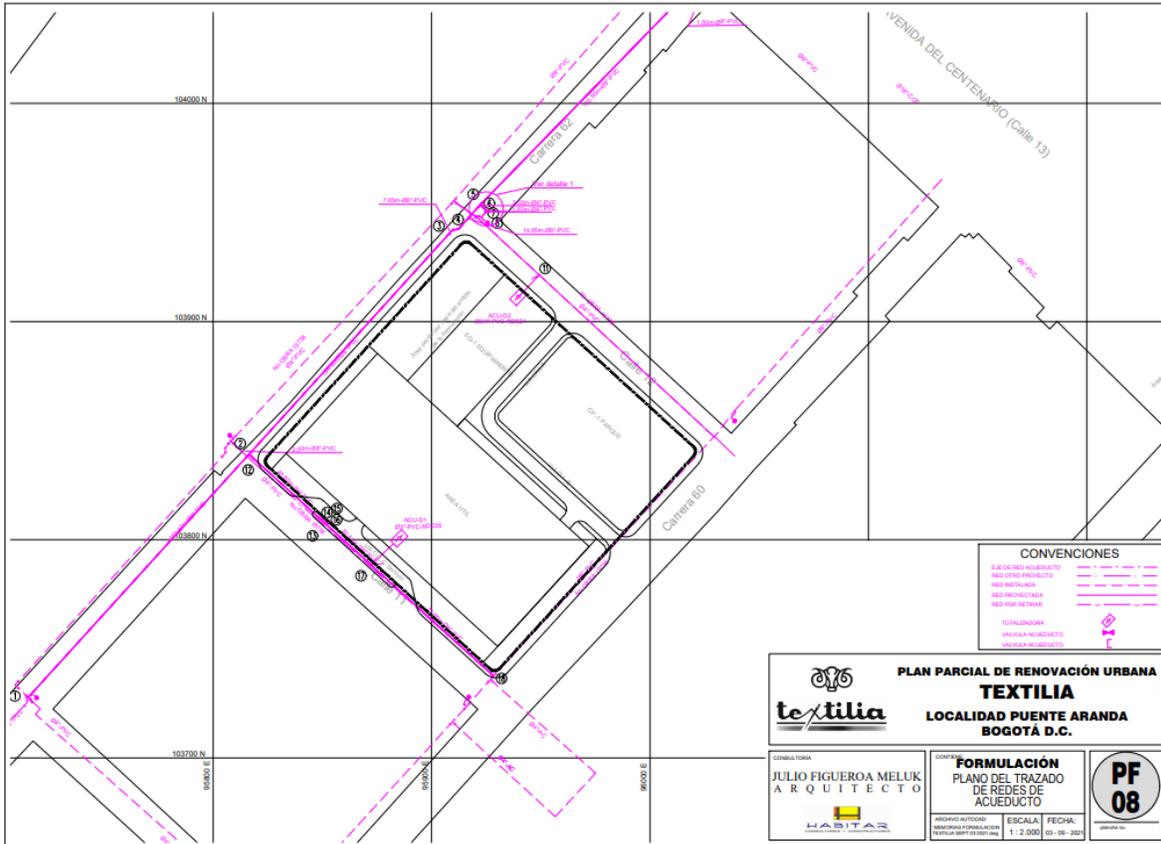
PF 08. Trazado de Redes de Acueducto
